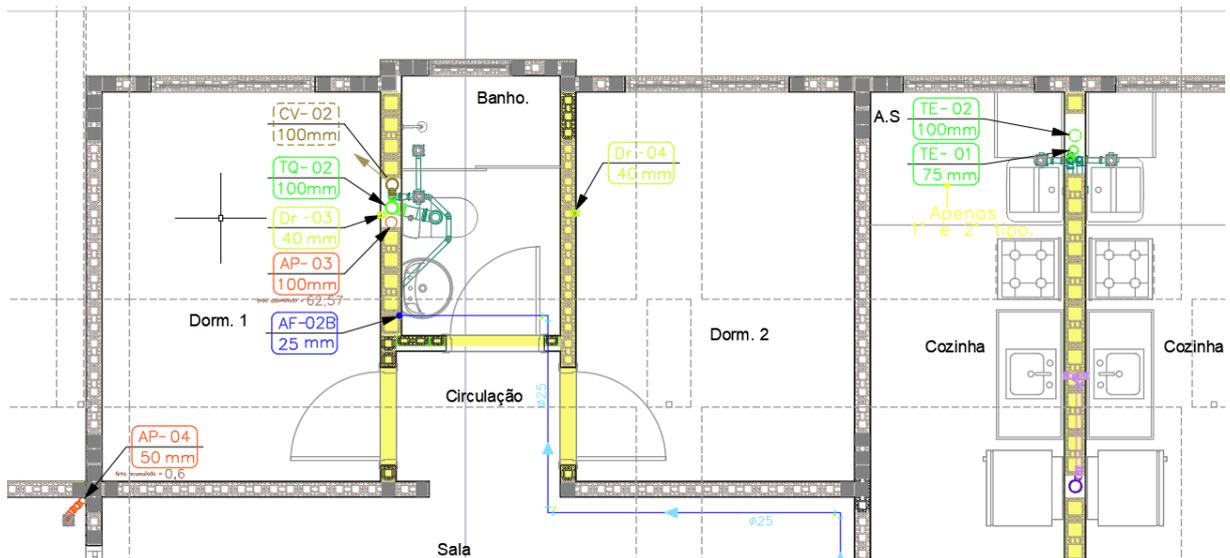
Detalhe de modulação Alvenaria Estrutural no Autocad.
